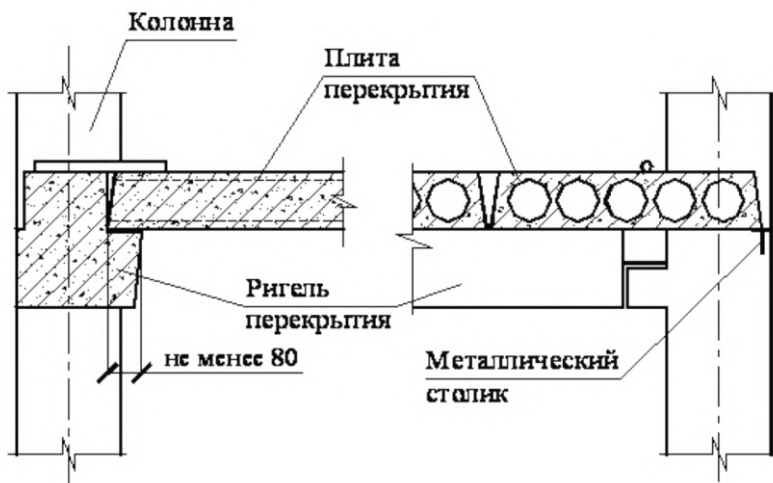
Схема опирания многопустотных плит на ригель по крайней оси
